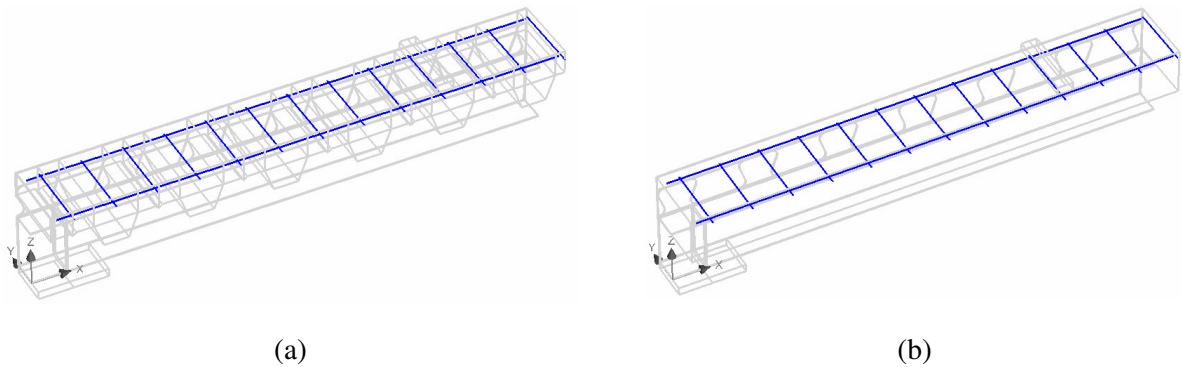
Geometria da armadura no programa de cálculo *ATENA 3D*: (a) Viga mista com laje de concreto nervurada; (b) Viga mista com laje de concreto maciça.
